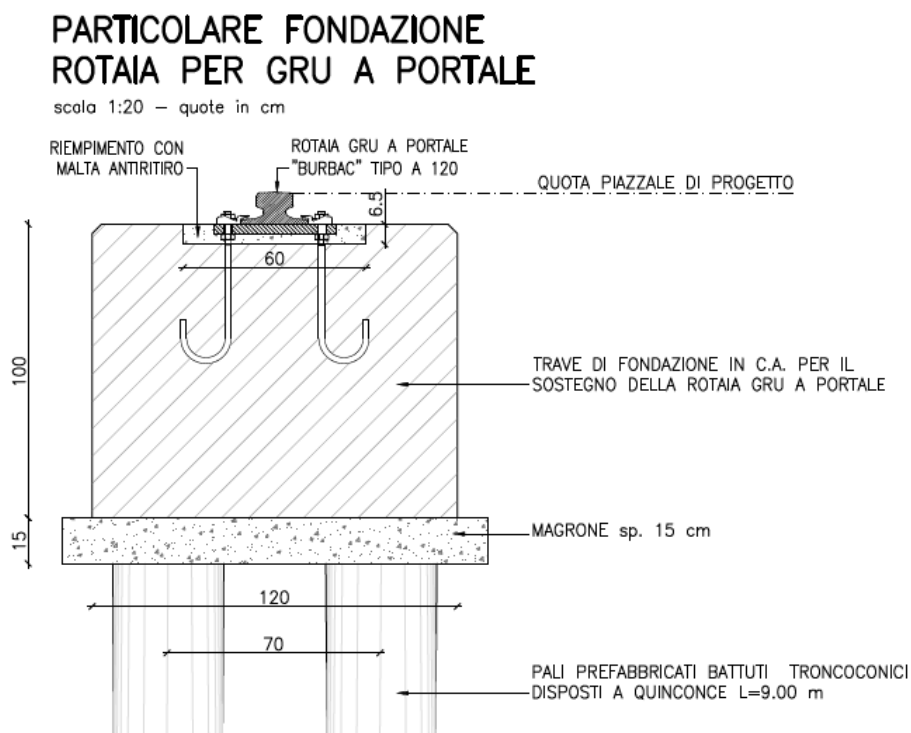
Sezione tipologica della trave di fondazione e della rotaia di corsa per gru a portale
